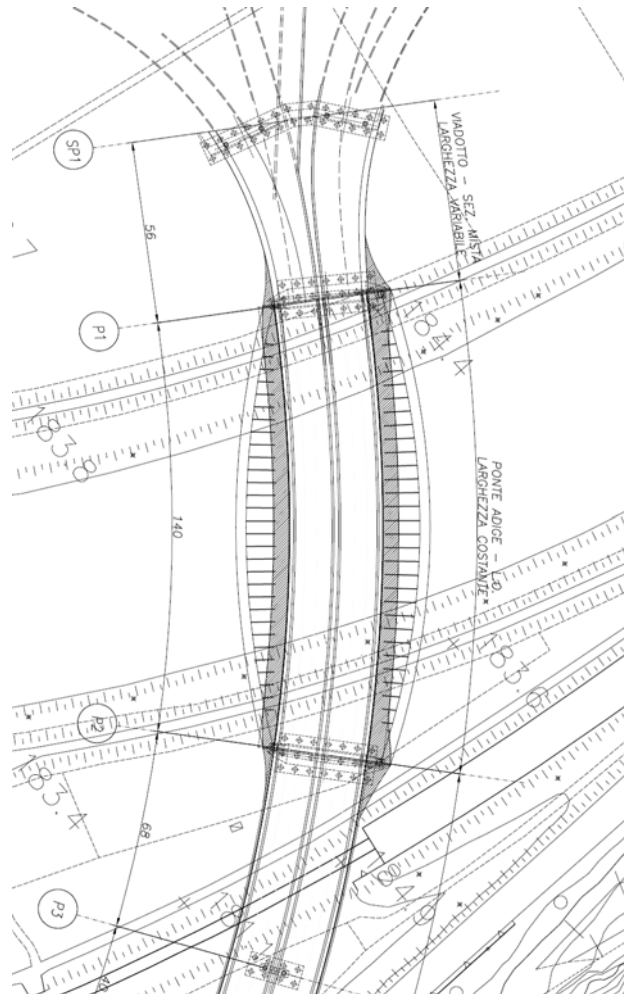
Stralcio planimetrico del tracciato in corrispondenza dell'opera
